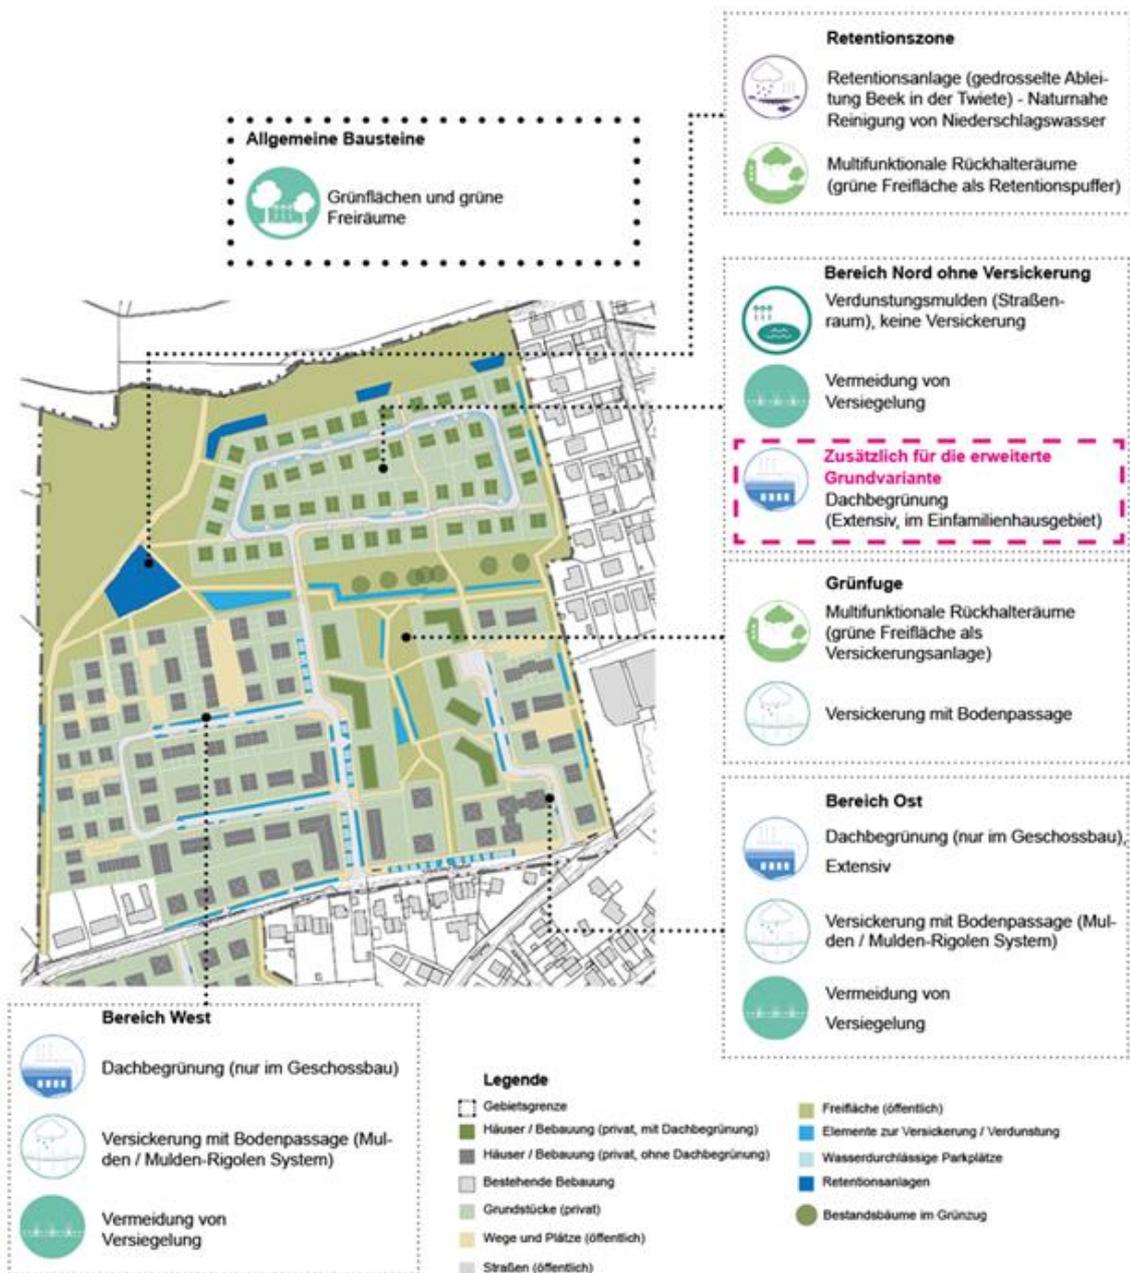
Plandarstellung mit dem Baustein einer zusätzlichen Dachbegrünung auf den Einfamilienhäusern im nördlichen Teil, erweiterte Grundvariante (Ramboll Studio Dreiseitl)
